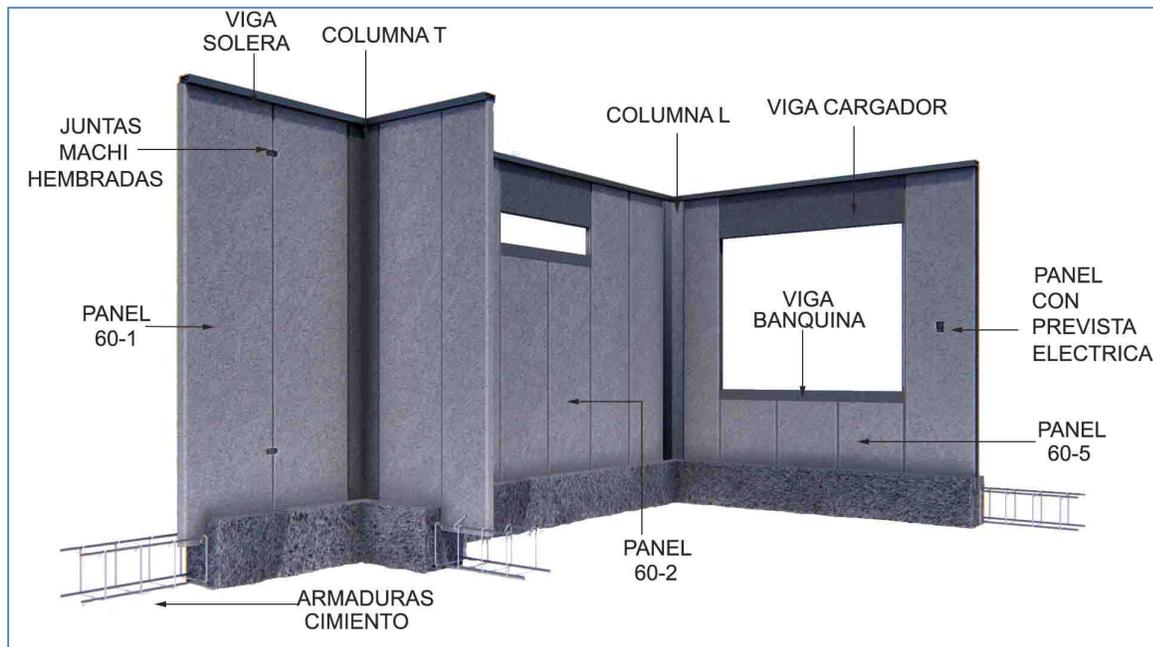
Detalle completo sistema de Prefabricado Vertical.
